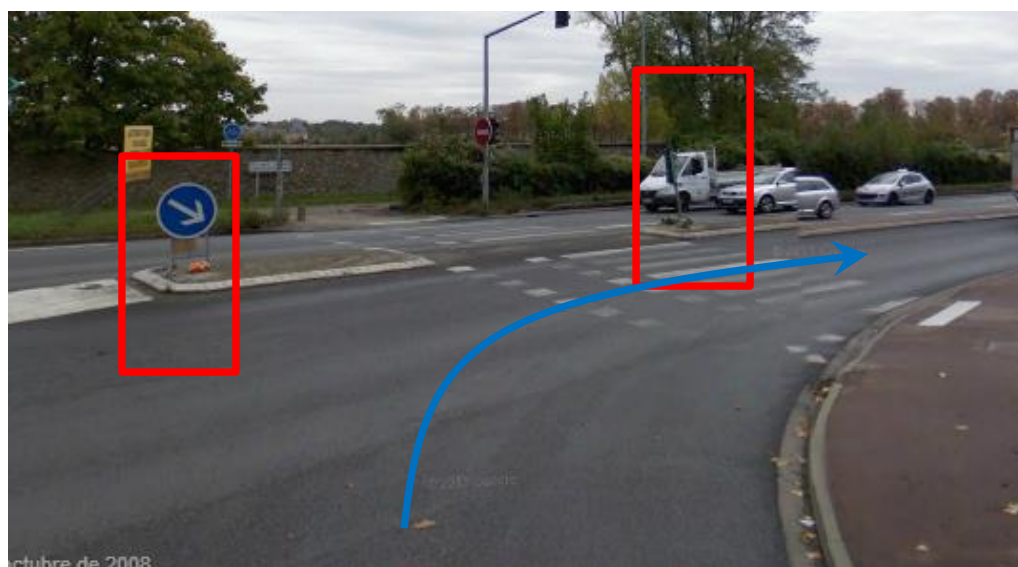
Ruta en azul. Hacer desmontables los elementos indicados.
